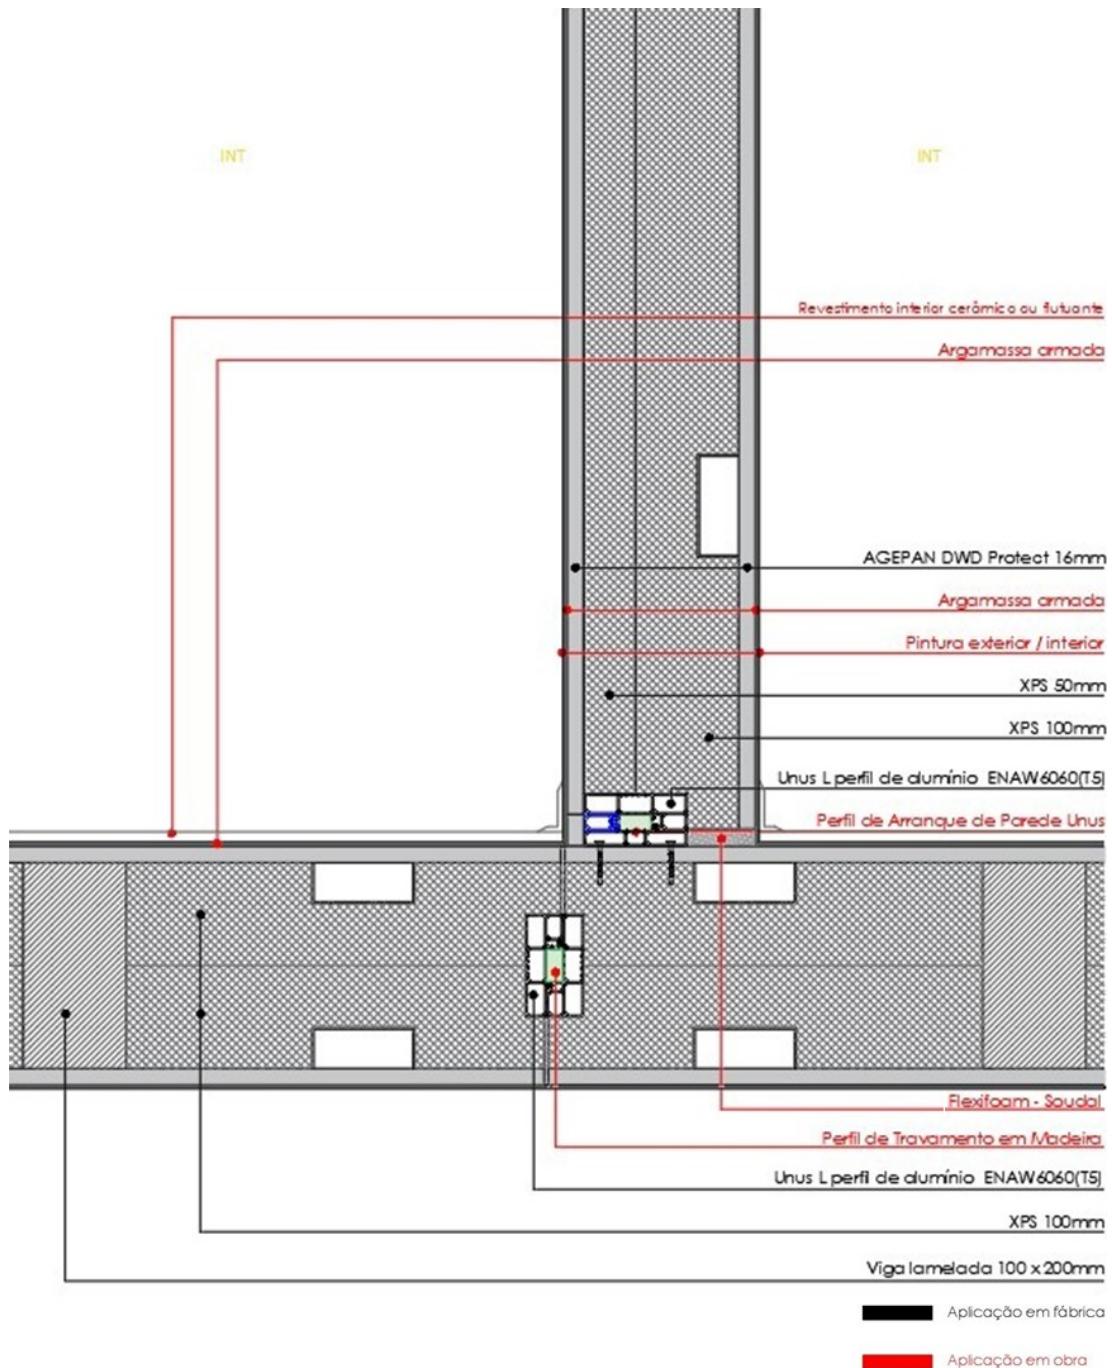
Solução Final – Pormenor construtivo de piso/parede interior.
